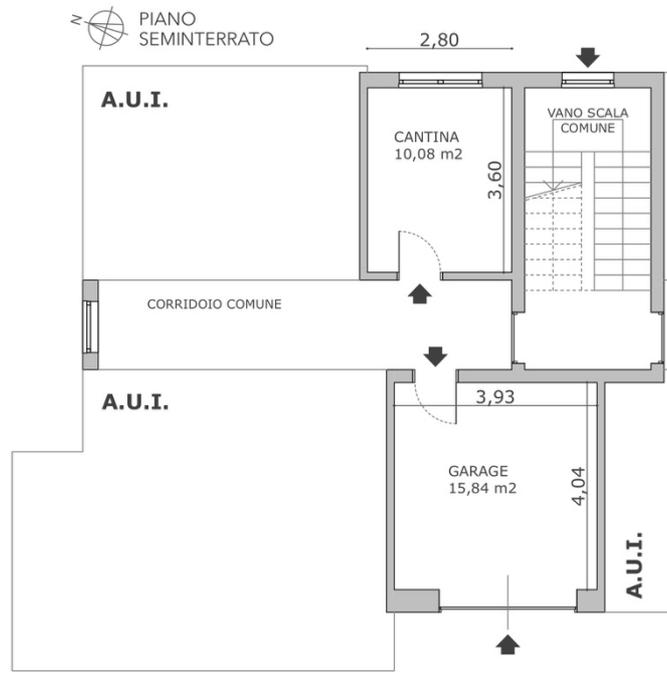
Planimetria cantina e autorimessa piano seminterrato
